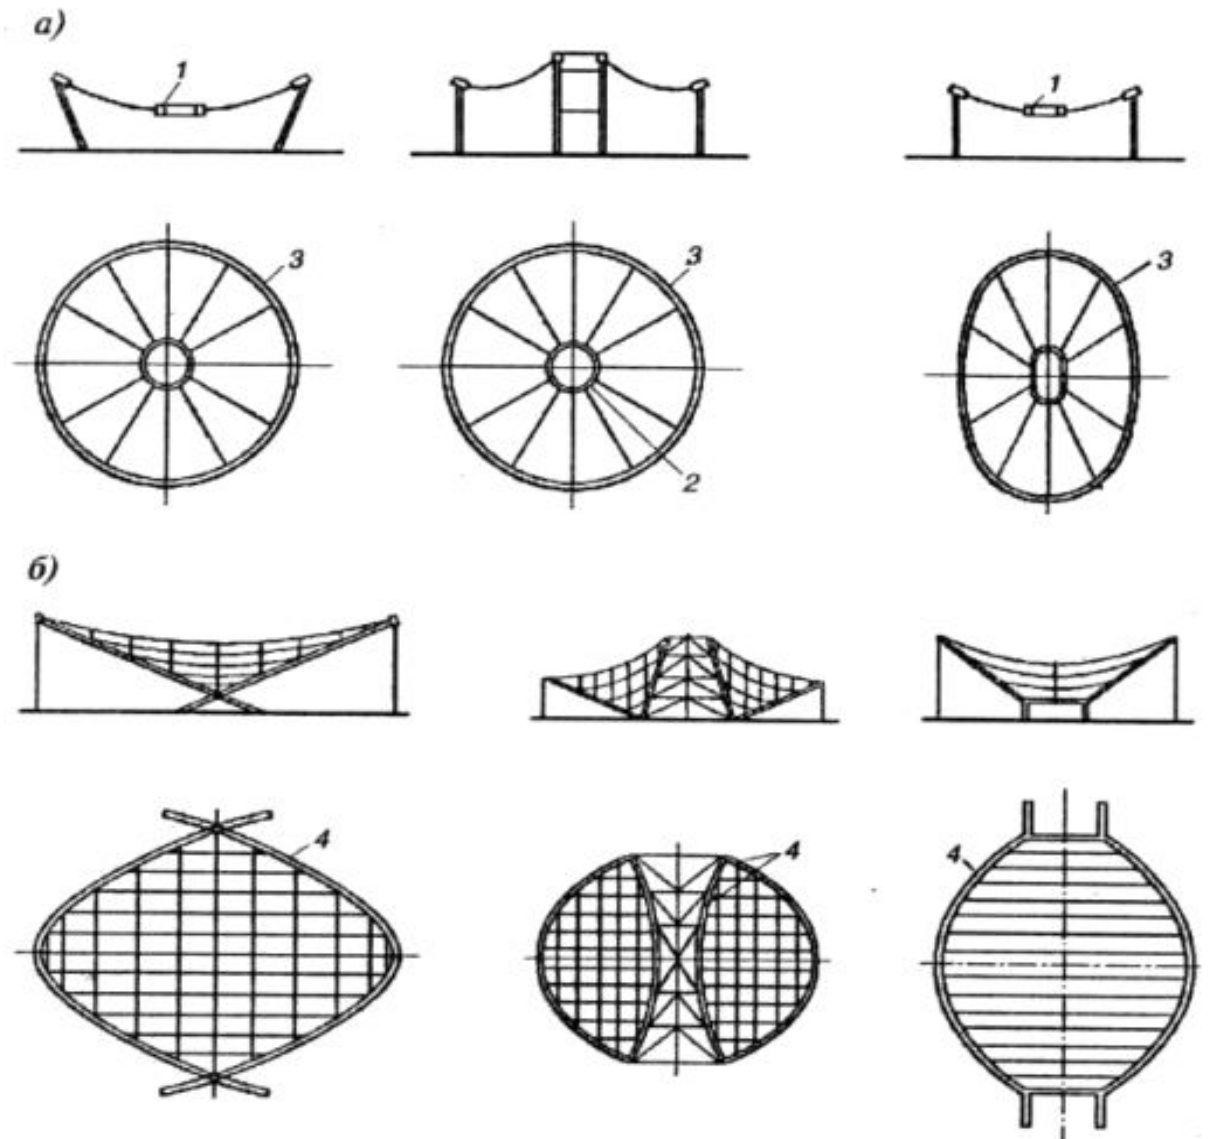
Схемы круглых и арочных опорных конструкций: а – круглых; б – арочных; 1 – внутреннее кольцо; 2 – то же, опорное; 3 – наружное опорное кольцо; 4 – опорные арки
